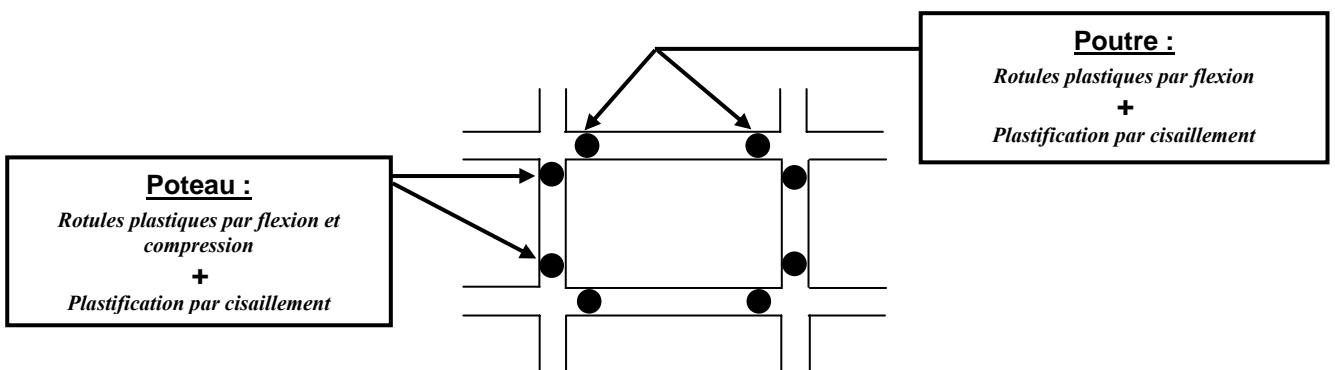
Rotules plastiques attribuées aux poutres et poteaux du portique.
